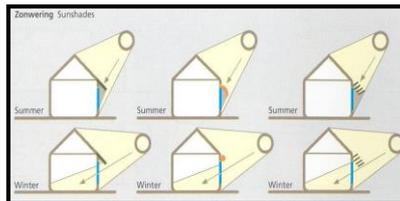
SCHÉMA ZONWERING, SOURCE : ADEME PROTECTION SOLAIRE
